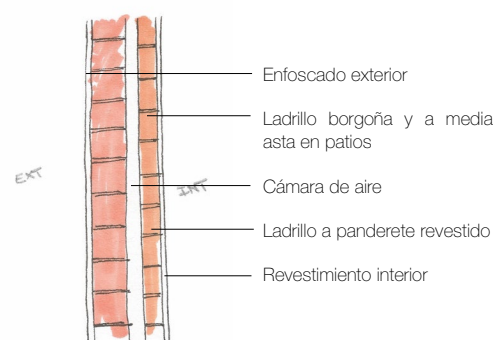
Sección de pared en balcón y terraza (autoría propia).
